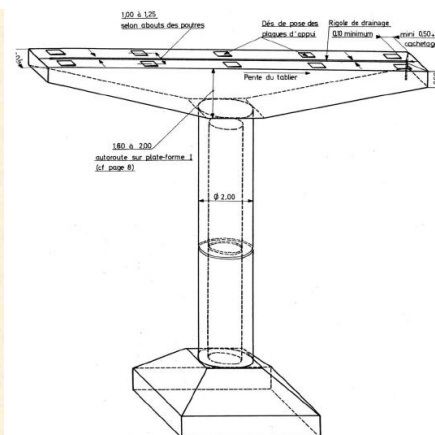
Piles à multiples colonnes et colonne centrale avec chevêtre
